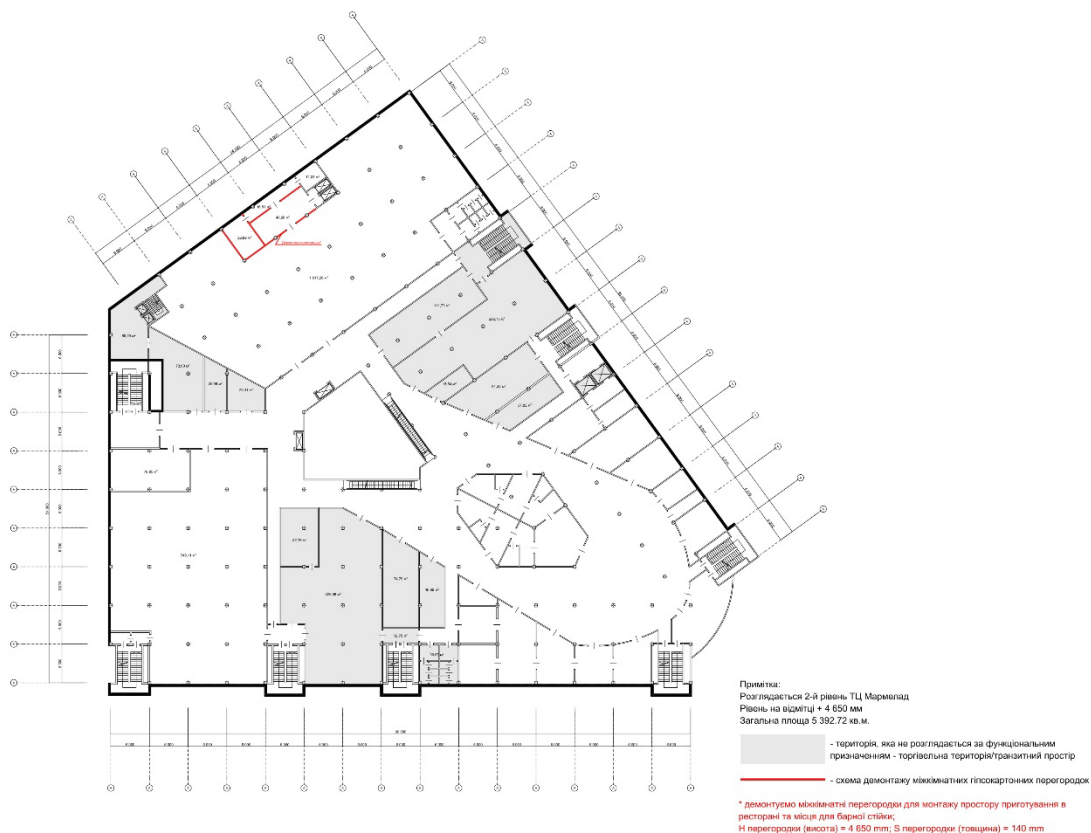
Схема демонтажу міжкімнатних перегородок
